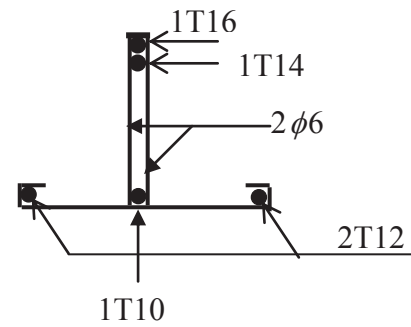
Schéma de ferrailage des poutrelles types 2, 3, 4 et 5 du plancher R.D.C.
